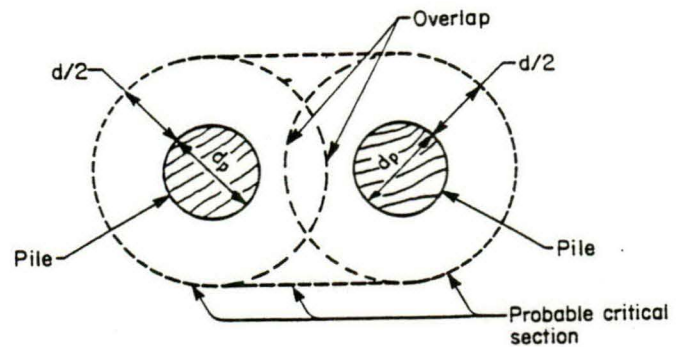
Sección crítica modificada para corte con perímetros críticos traslapados.
